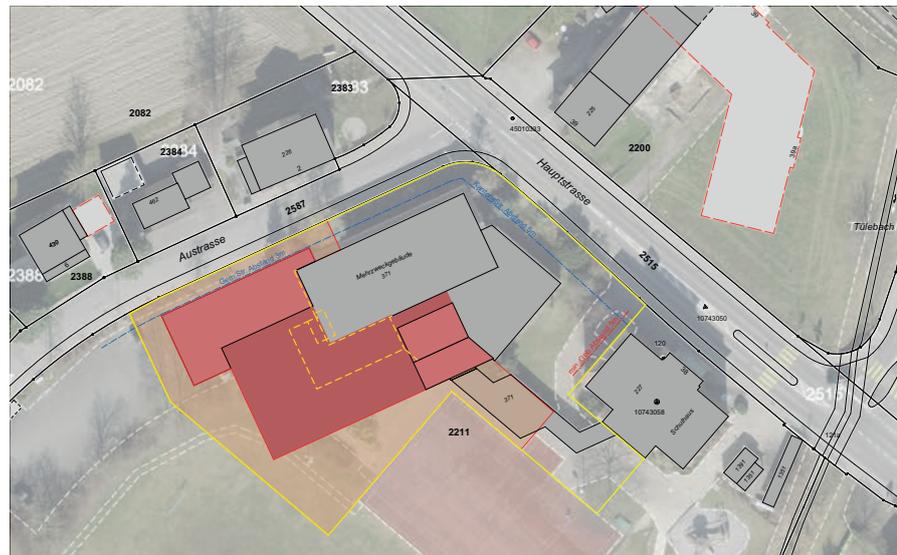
Situation Feindispo, 15.4.25 (Hinweis: Vergrösserung siehe Planbeilage)
